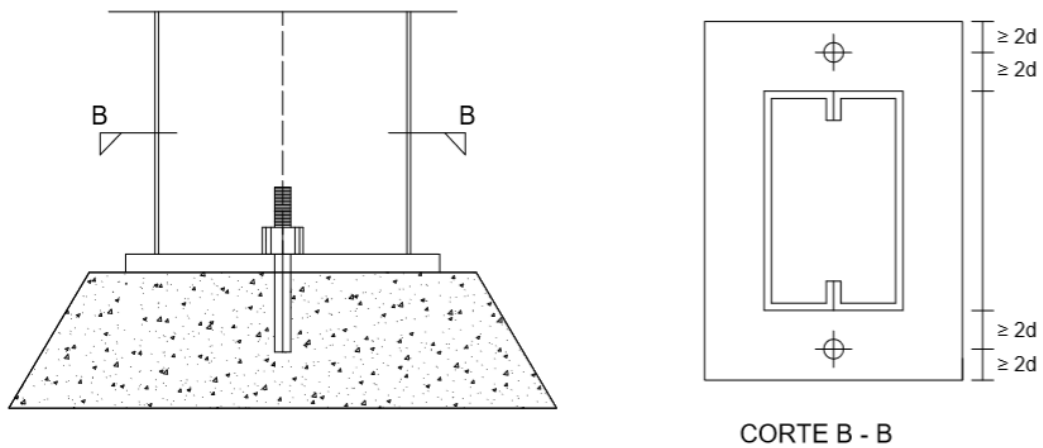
Aparelho de apoio para pilares centrados (De PAULA, 2016)
